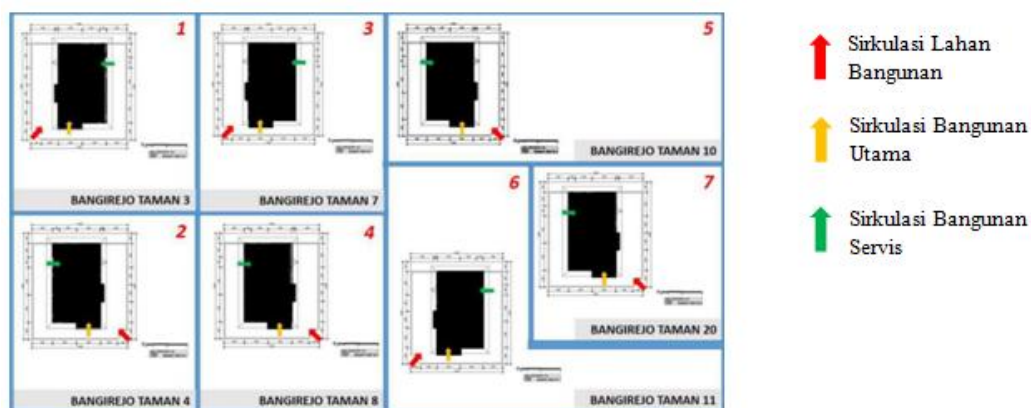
Diagram Bentuk dan Susunan Ruang Bangunan Rumah Tinggal di Kawasan Bangirejo Taman.
